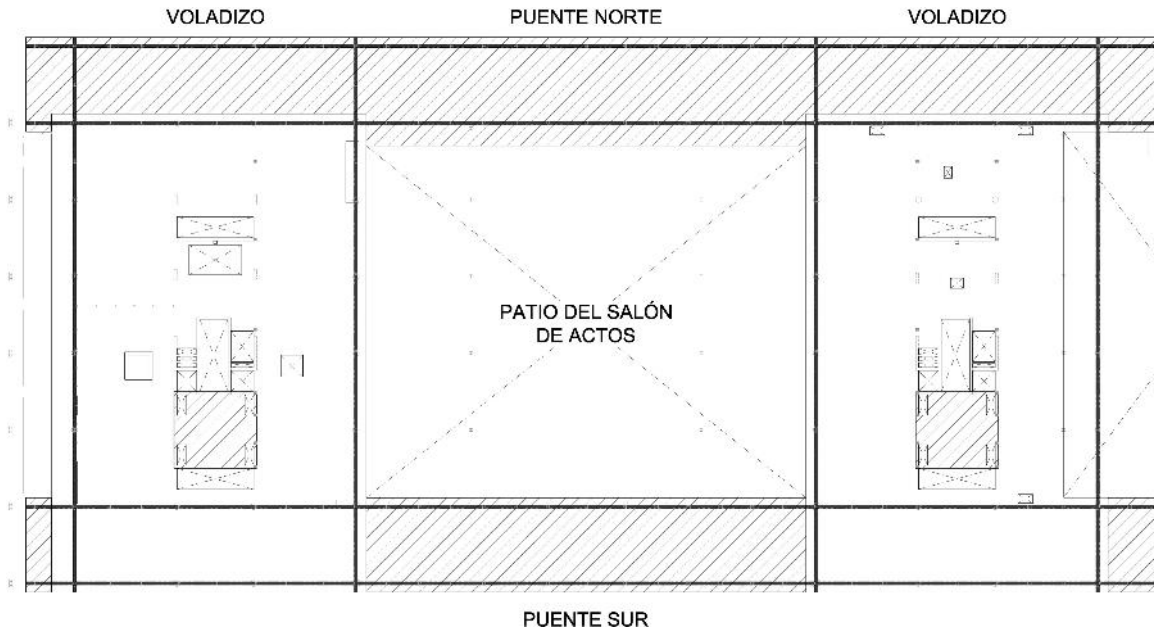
Nivel de planta «presidencial» (cuarta). Mitad oeste. Las áreas tramadas corresponden a la superficie de forjados de planta cuarta y quinta colgados de la estructura de cubierta.
